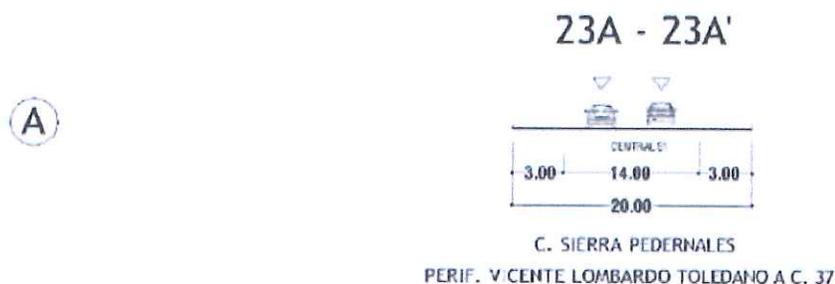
Sección vial actual para calle Sierra Pedernales. Fuente PDU 2040.
